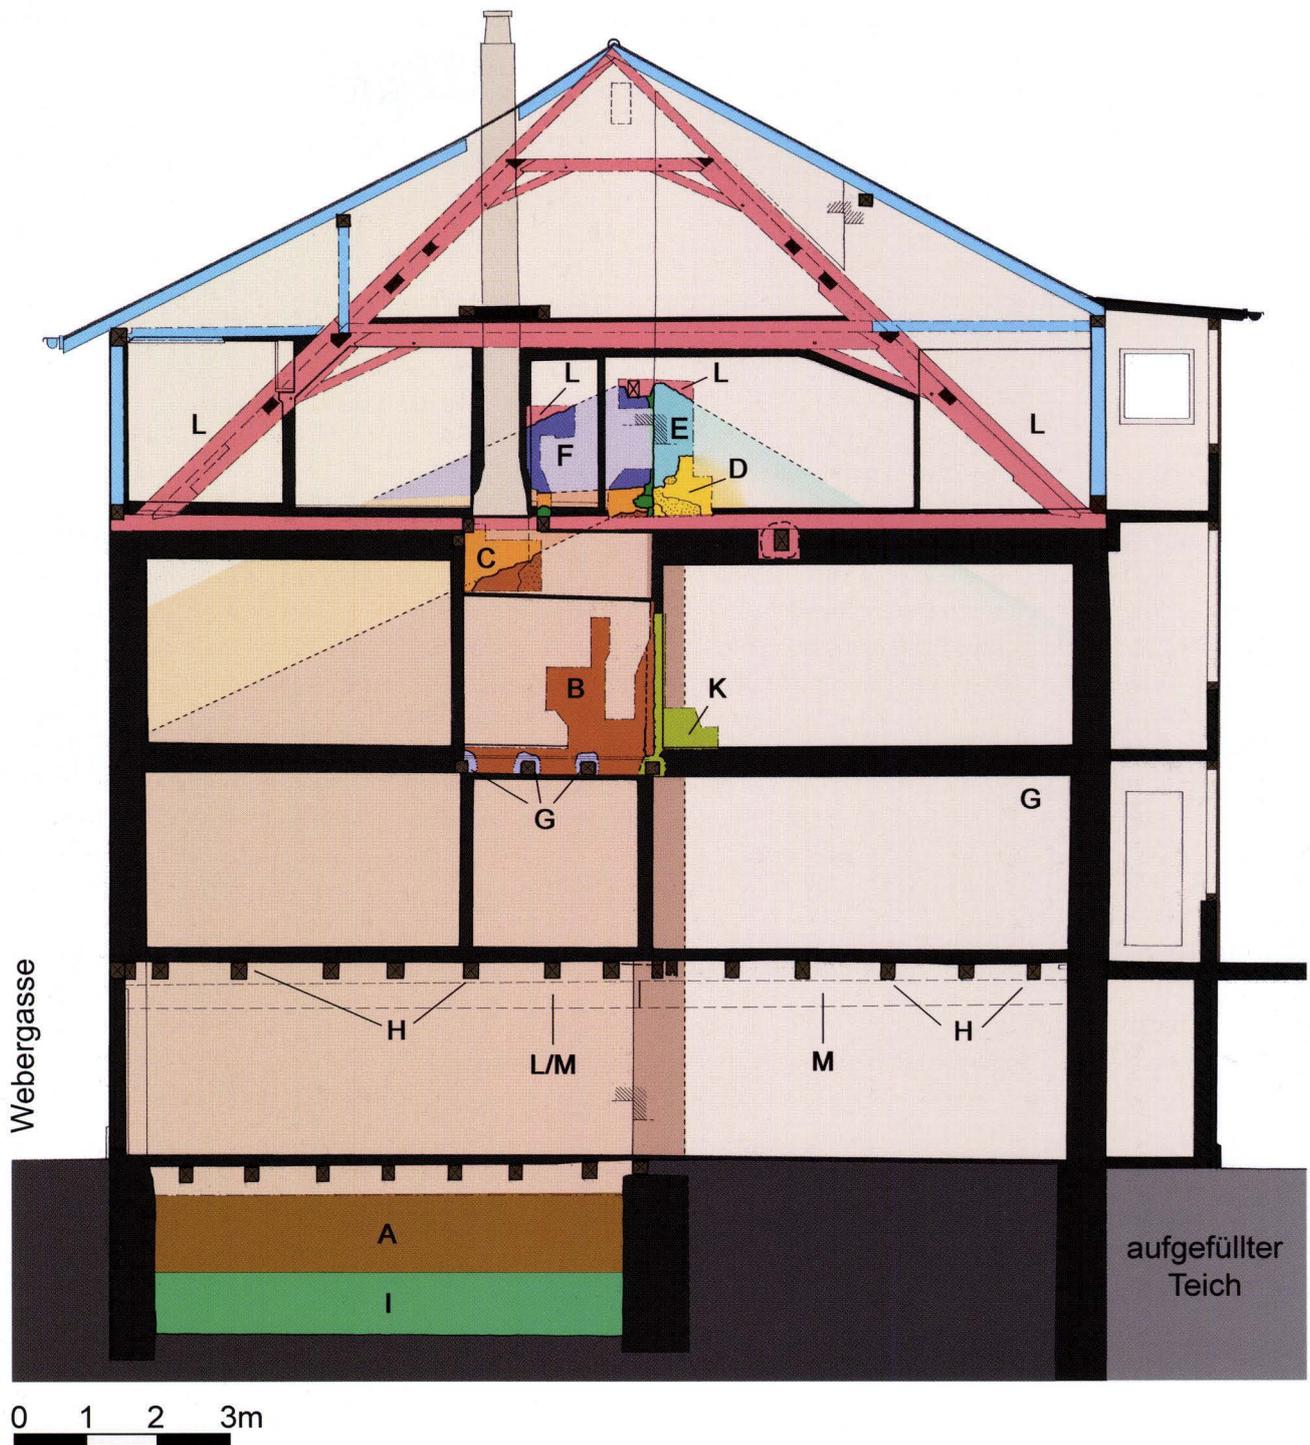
Webergasse 29. Schnitt durch das Gebäude und Ansicht der westlichen Brandmauer, mit Eintrag der Bauphasen und einer ergänzenden Darstellung der Vorgängerbauten. Das Mauerwerk A gehört zu der benachbarten Bebauung an der Webergasse 27. Baukörper B stand an der Webergasse 29, erstreckte sich bis an den Versatz der heutigen Brandmauer und wies eine zur Strasse hin abfallende Dachfläche auf. Die hintere Massivmauer des Baukörpers B stand in der Flucht der hinteren Kellerwand und wurde wohl im 14./15. Jahrhundert errichtet. Die Scheidemauererhöhungen C und D dürften bei einer Erhöhung von Webergasse 27 erfolgt sein. Die Mauer F ist eine Erhöhung des Baukörpers B und bildet mit E eine satteldachförmige Giebelwand. Die Balken G wurden um 1516/17 (dd) eingebaut. Die Balken H erstrecken sich über die halbe Hausbreite und wurden bei der Teilung des Gebäudes um 1562/63 (dd) eingebaut. Im westlichen Hausteil wurde ein Keller I angelegt. Das Flickwerk K stopft die Abbruchwunde der hinteren Massivmauer von B und stammt aus einem die ganze Gebäudebreite betreffenden Bauvorgang von 1670/71 (dd). 1736/37 (dd) erfolgte der Neubau des Dachwerks L. Der vordere Unterzug L/M ersetzte wohl um 1736/37 (dd) die im Erdgeschoss 1562/63 eingebaute Trennwand, der hintere Unterzug M erst um 1745/46 (dd). – Zeichnung: Basler Denkmalpflege, Conradin Badrutt und Stephan Tramèr.
